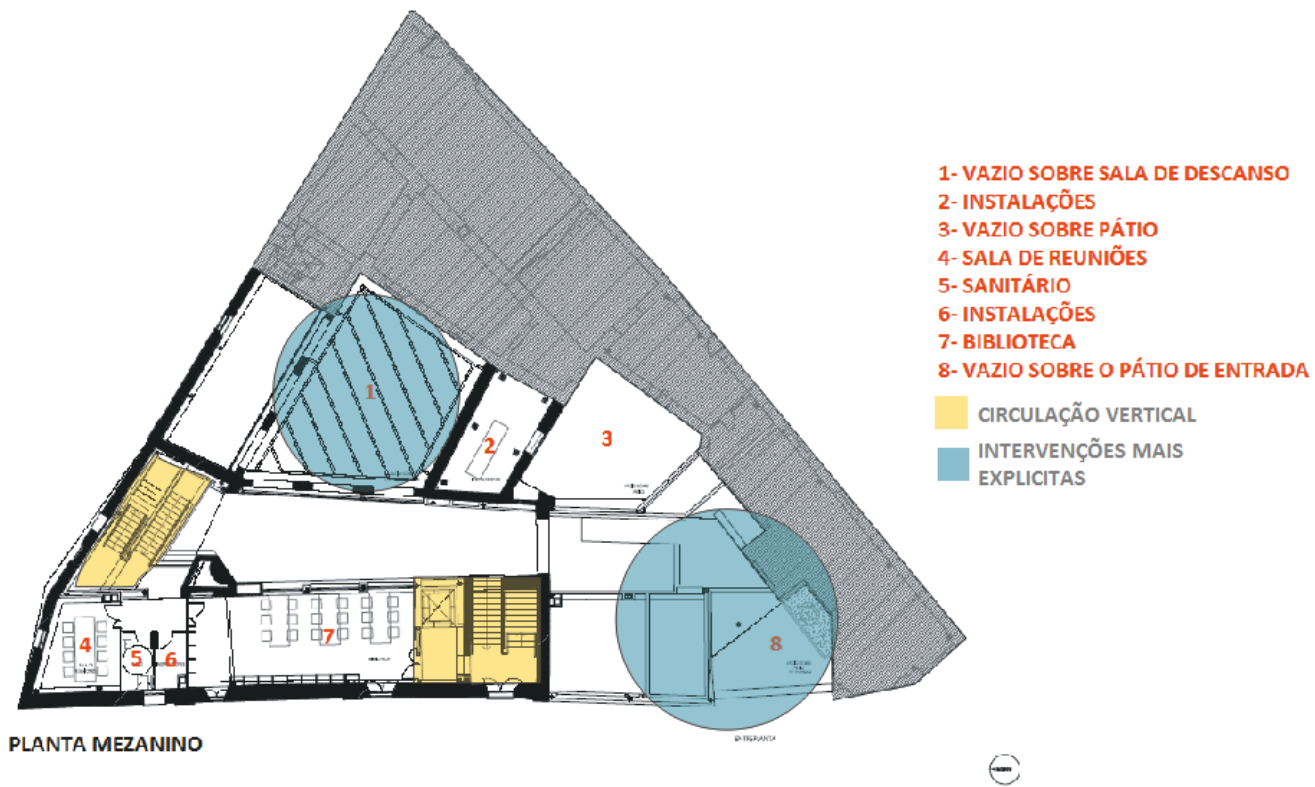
PLANTA MEZANINO DA INTERVENÇÃO.
